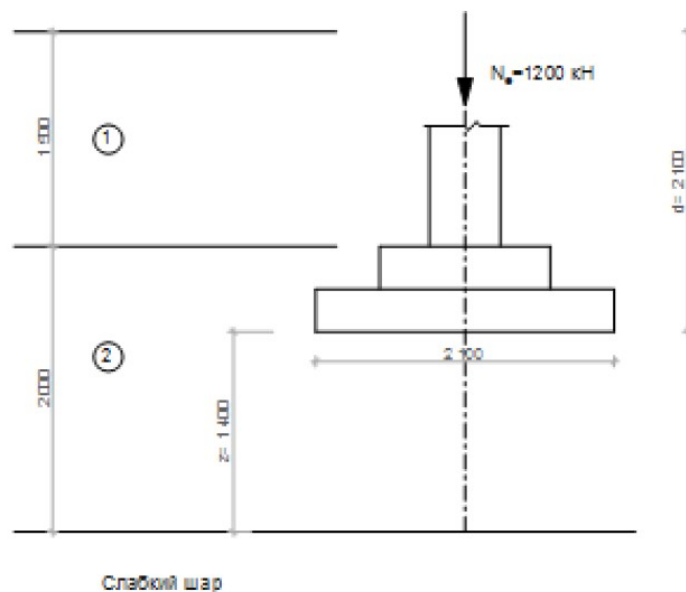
Розміщення фундаменту в ґрунті
